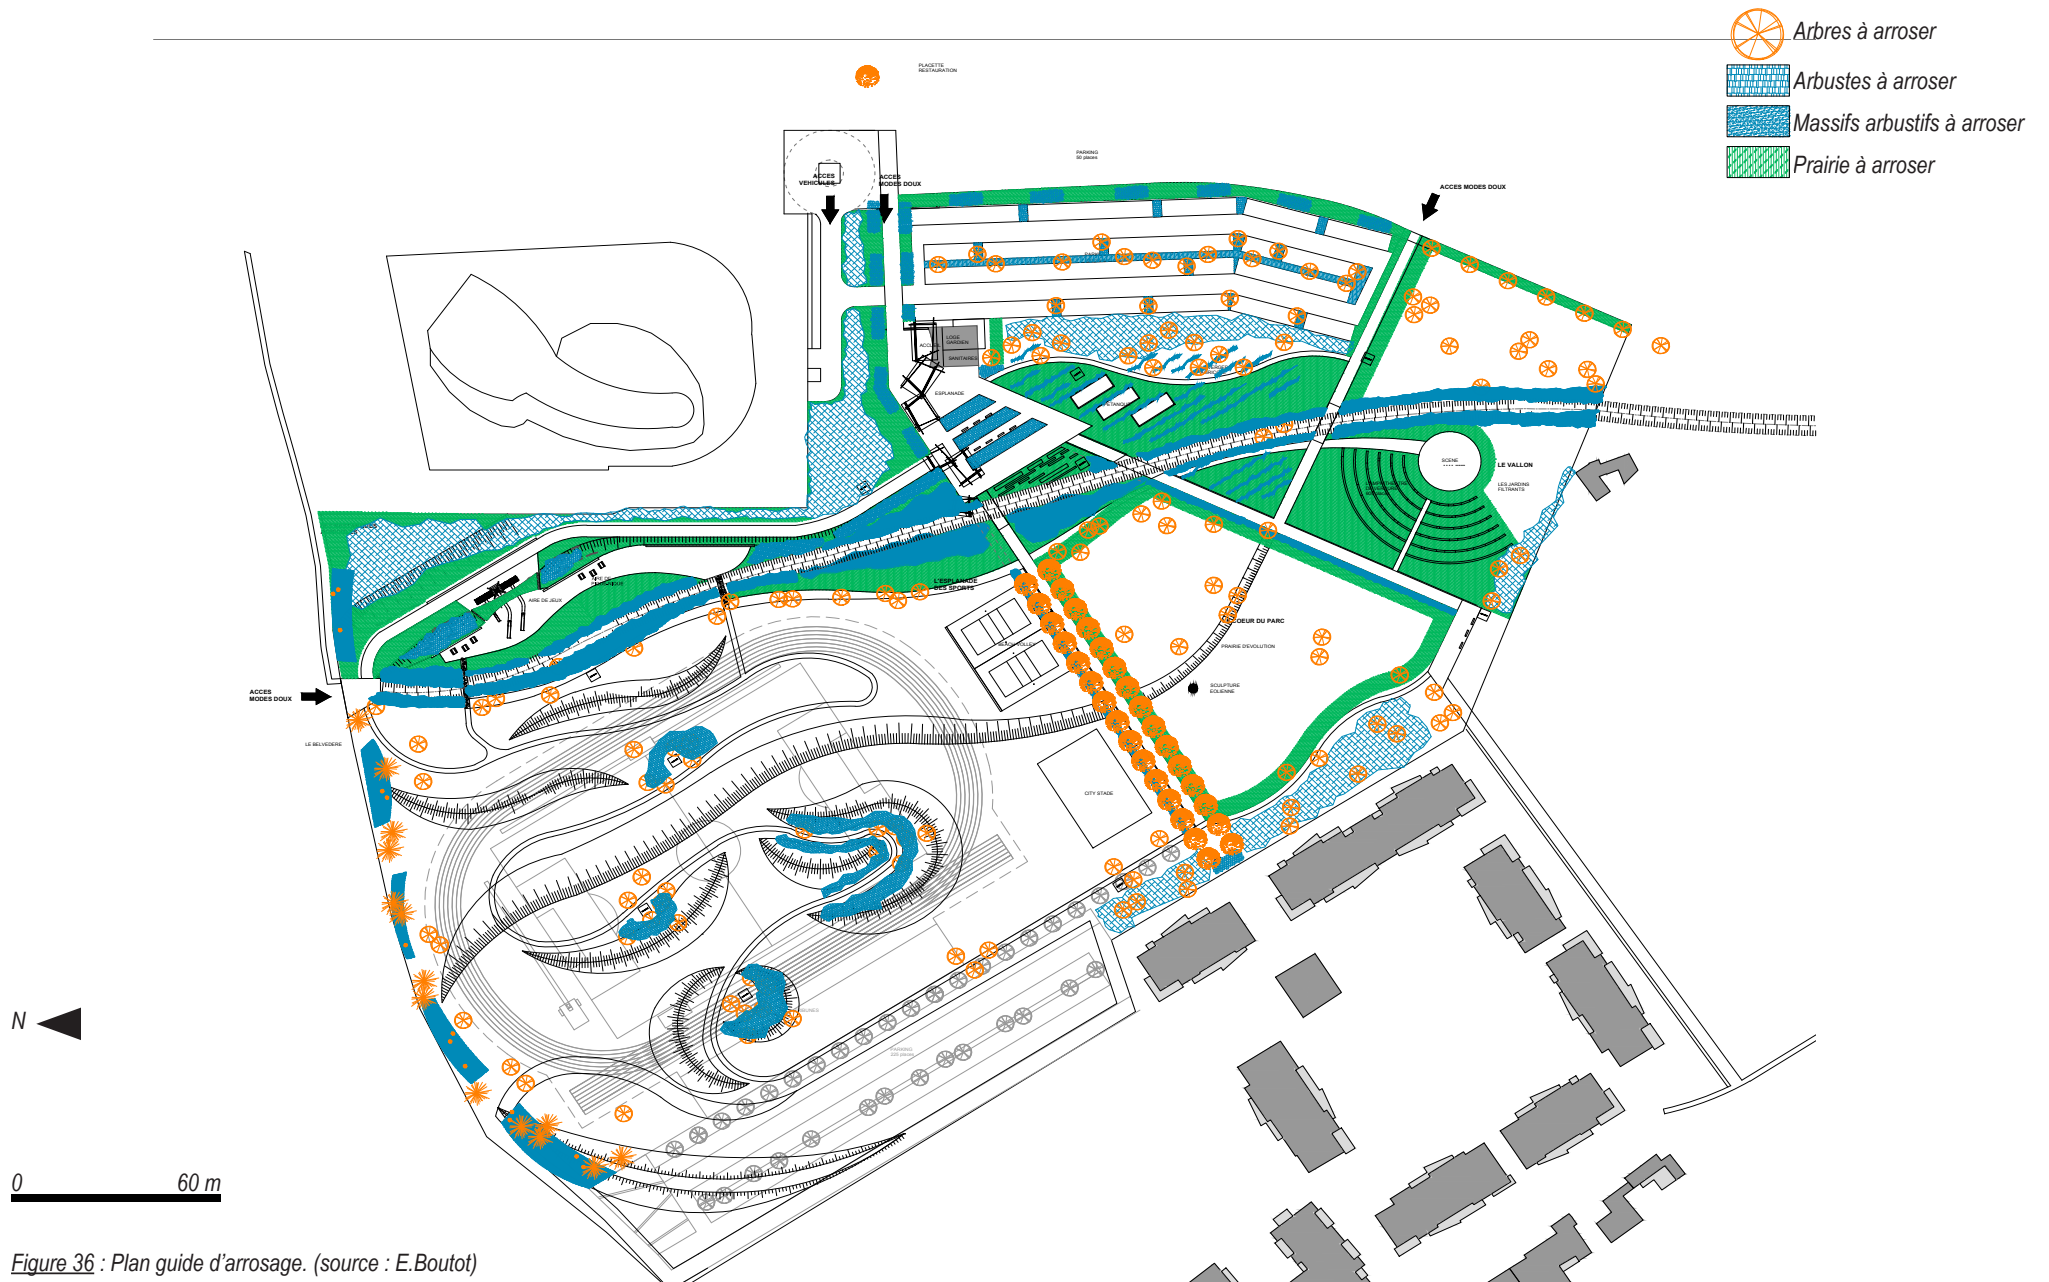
Plan guide d'arrosage. (source : E.Boutot)
